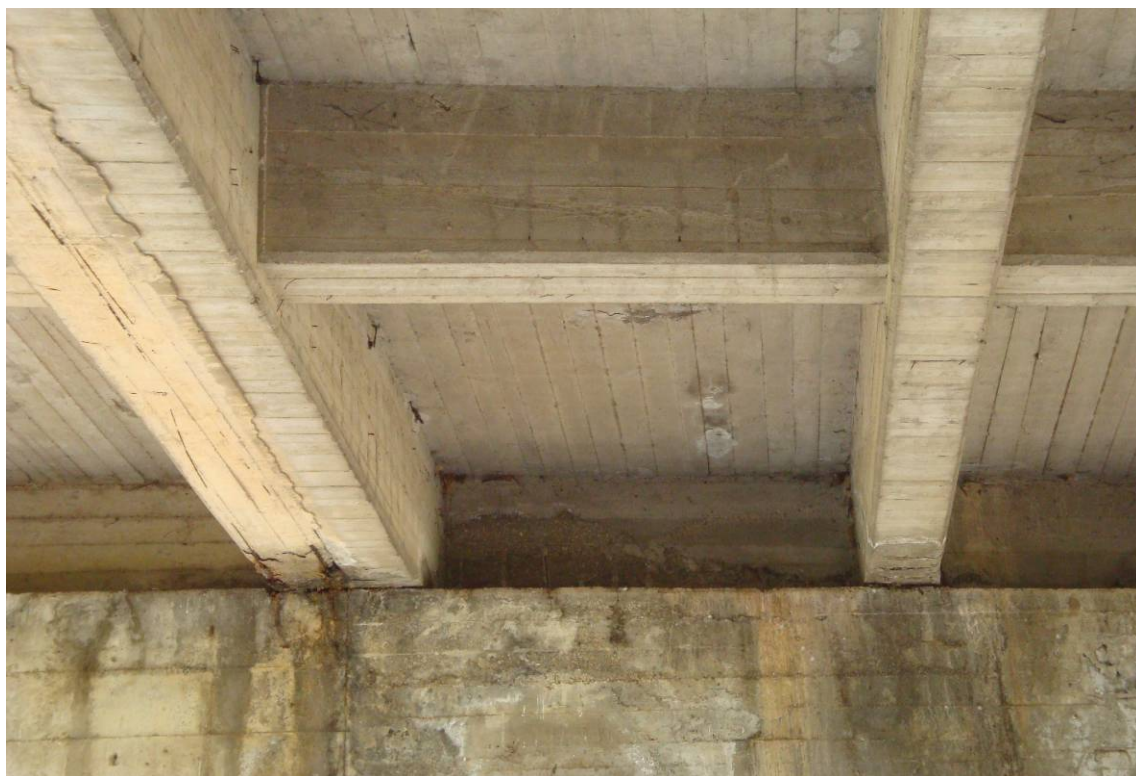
particolare intradosso impalcato - appoggio trave doppia
